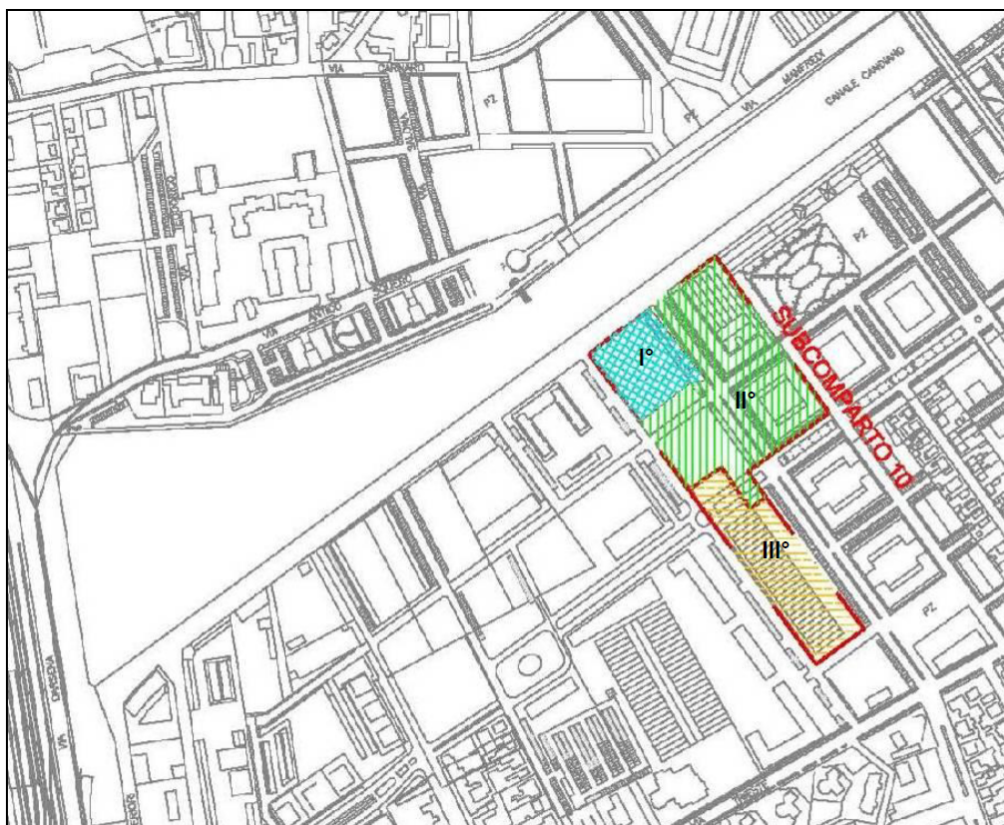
blu: I° Stralcio “area Torre” – verde: II° Stralcio da collaudare – giallo: III° stralcio “area Sigarone”.
